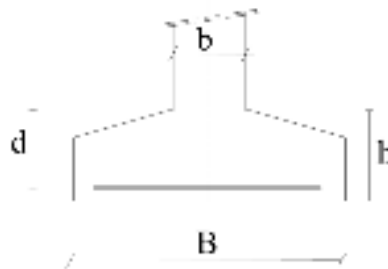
Dimensionnement d'une semelle isolée dans le sens y-y.
